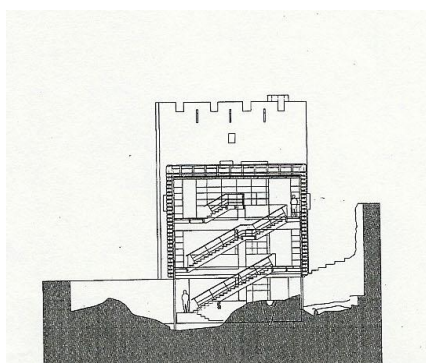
Vista lateral do novo elemento arquitectónico.
